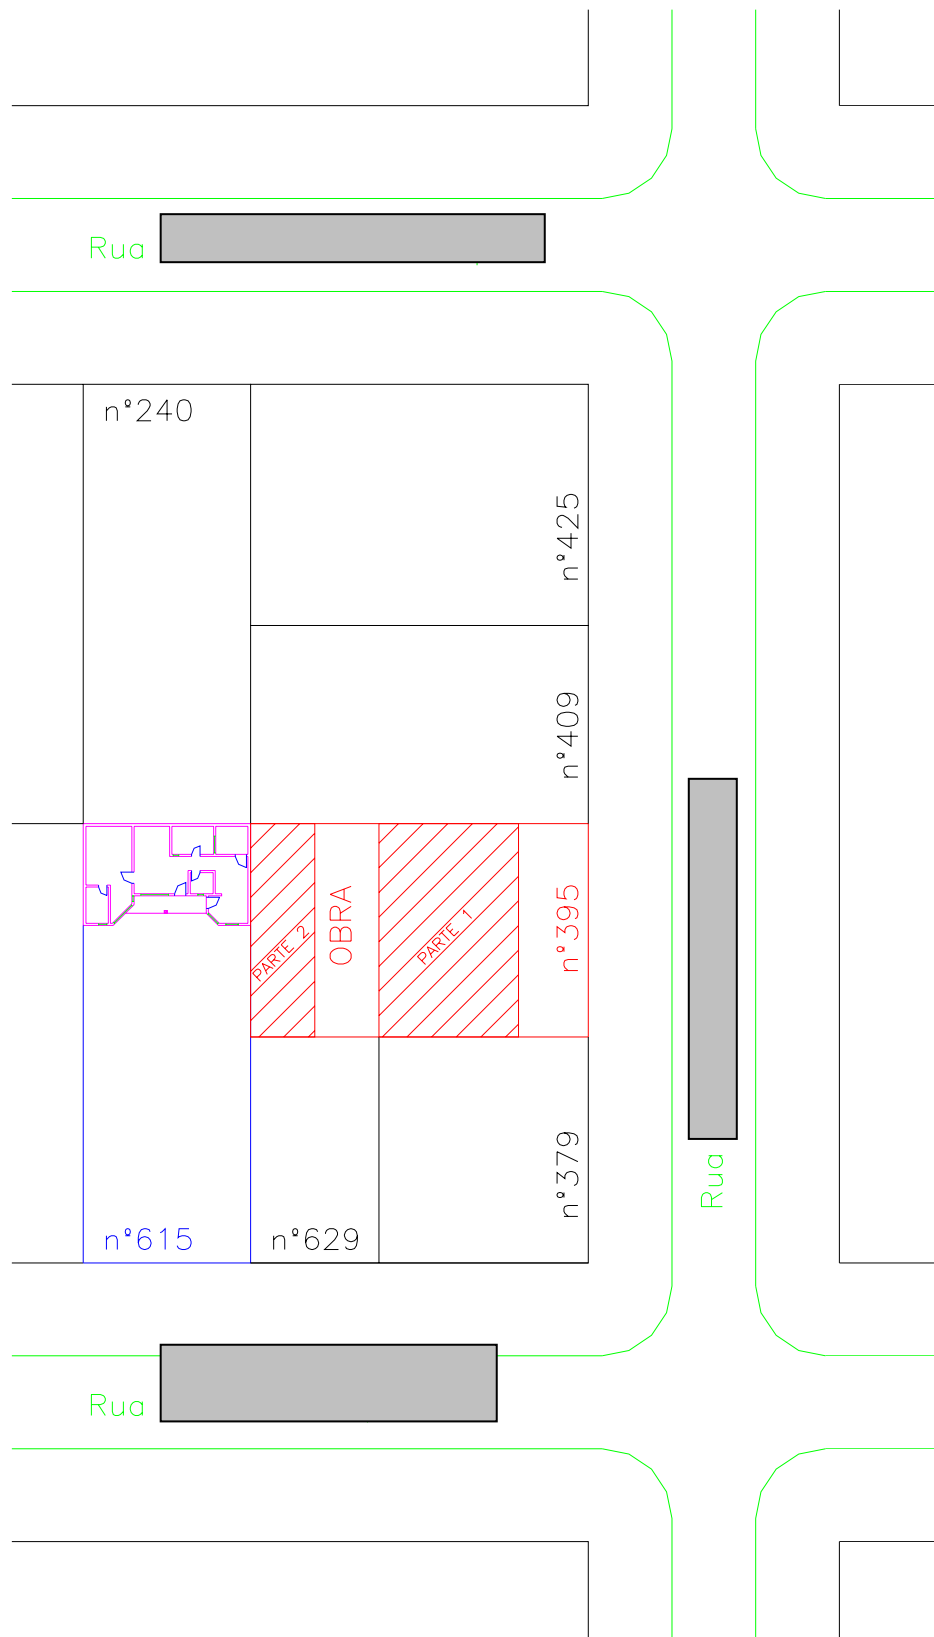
Planta de parte do quarteirão, indicando a posição da casa examinada (n° 615 da rua ) e da obra de construção em execução (n.º 395 da rua ).
